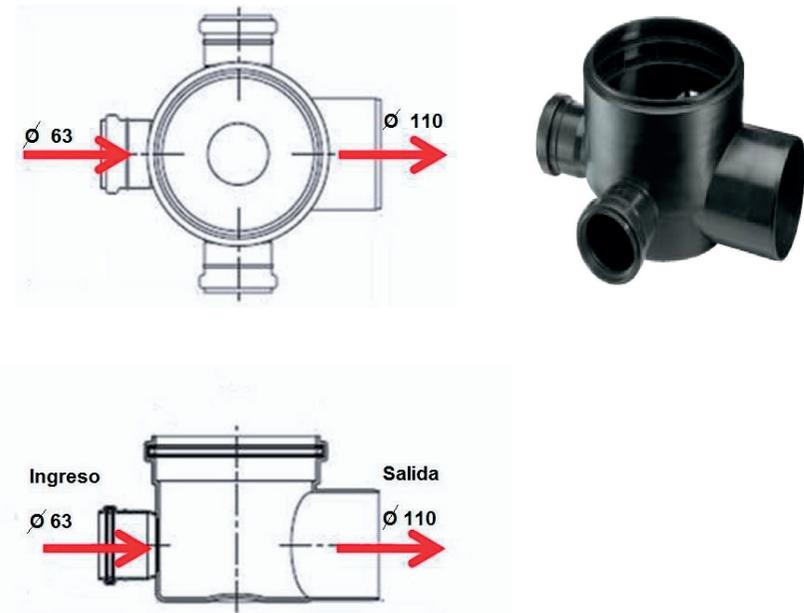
Boca de Acceso Tapada con 3 entradas. Planta, corte y vista.
